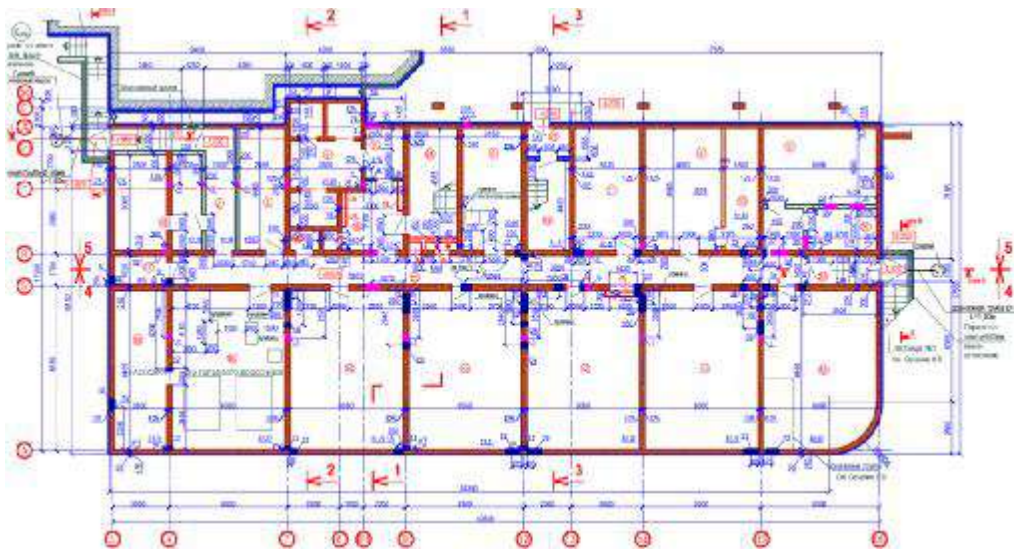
План підземного поверху будівлі №1 на відм. -3.000 м
